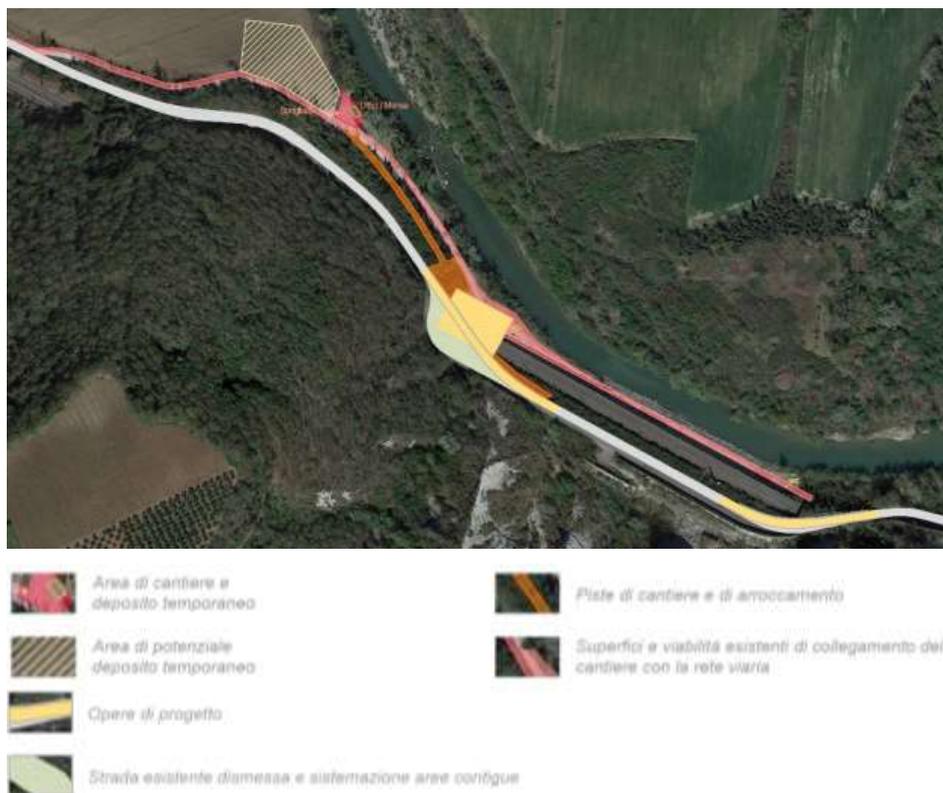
Planimetria delle aree di cantiere (Fonte: Lista di controllo)
